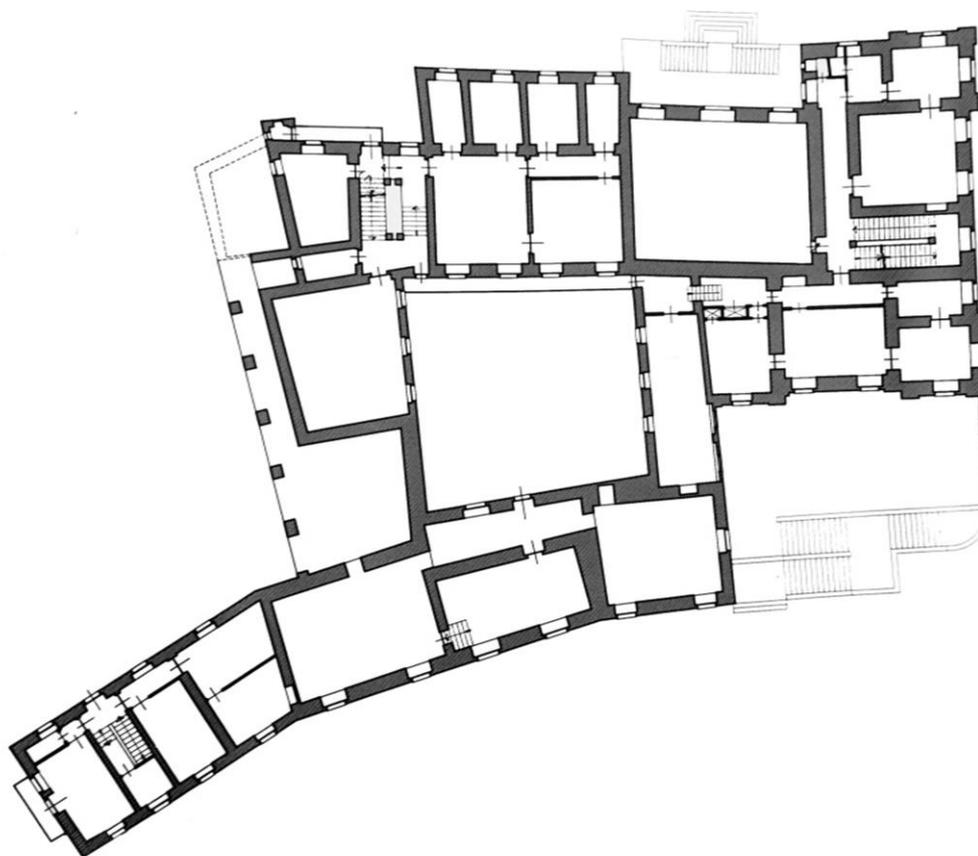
Planimetria Palazzo Canalis primo piano (Comune di Cumiana).
